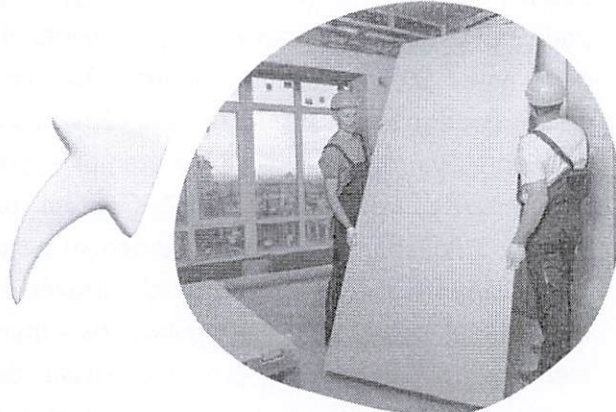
Arquivo Canva - Divisórias interna (drywall)
